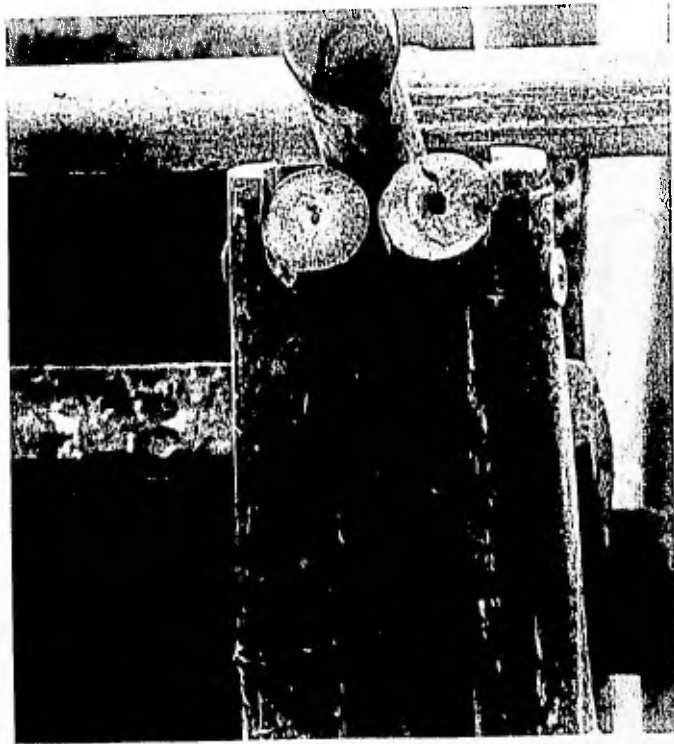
Extremo superior de los elementos diagonales estabilizadores fijados a la cuerda inferior de sección compuesta de la armadura.
